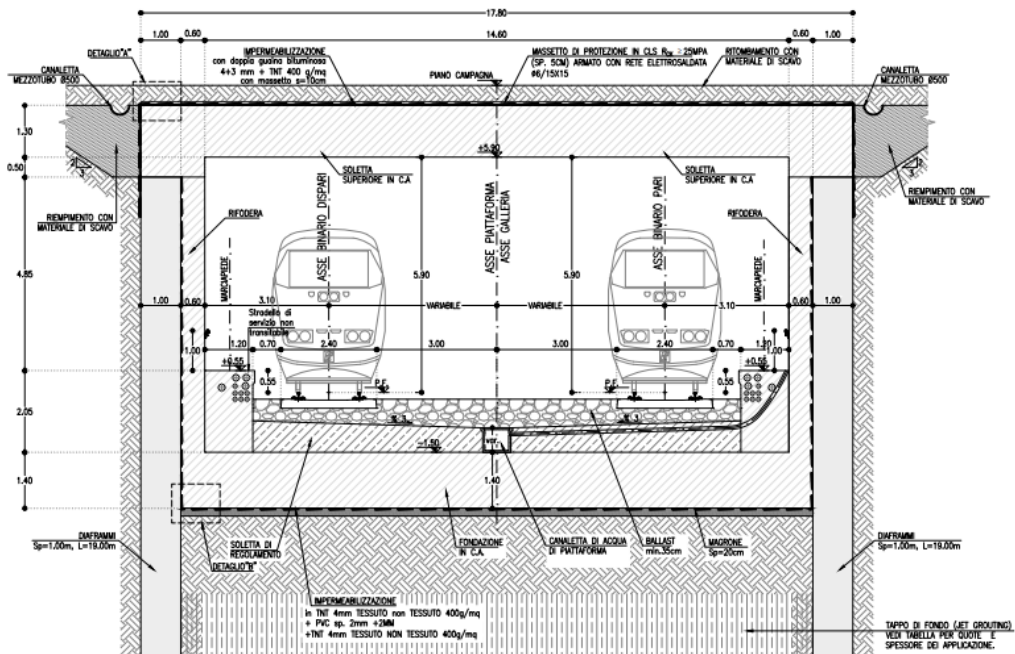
Sezione Galleria GA05 tratto su diaframmi
